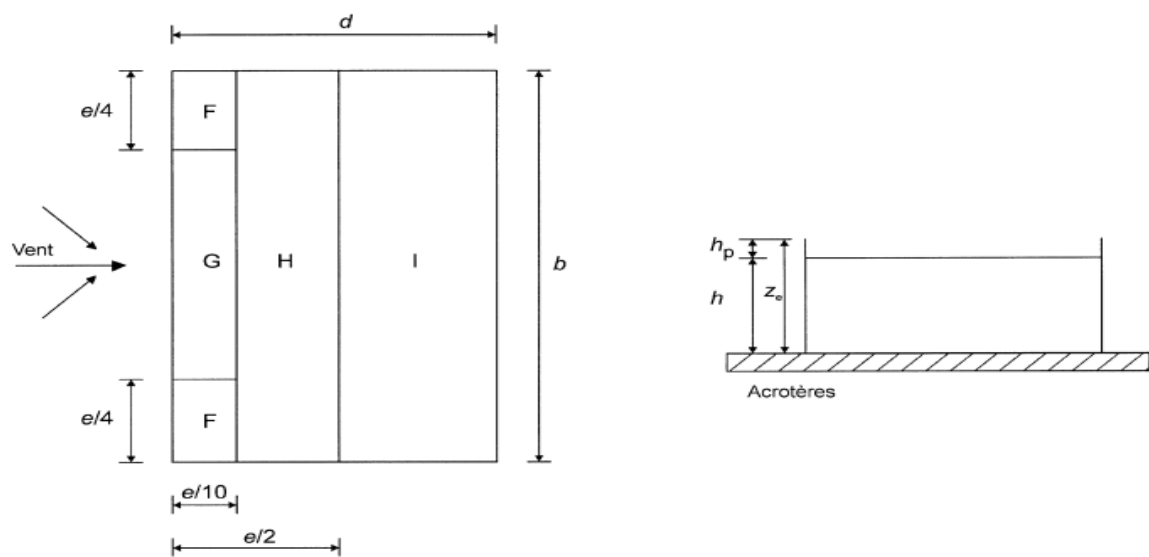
Vue en plan des zones de pression de la toiture plates.
